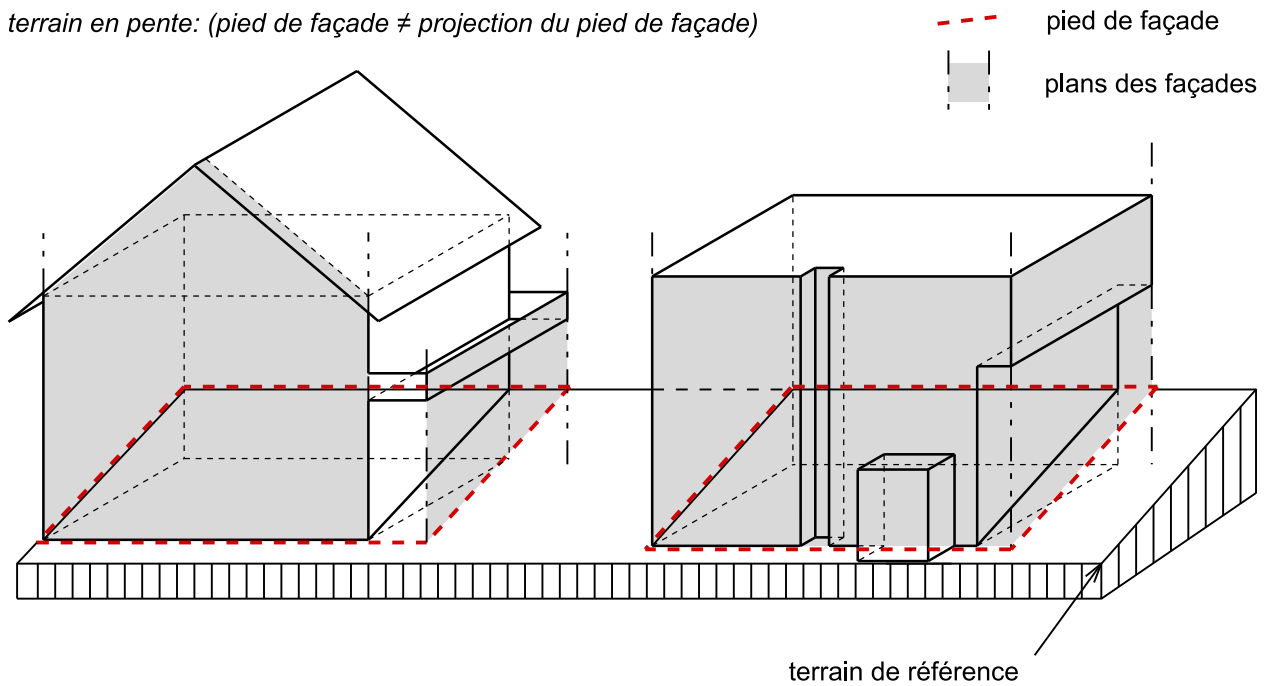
3.3 Plans des façades et projection du pied de façade
